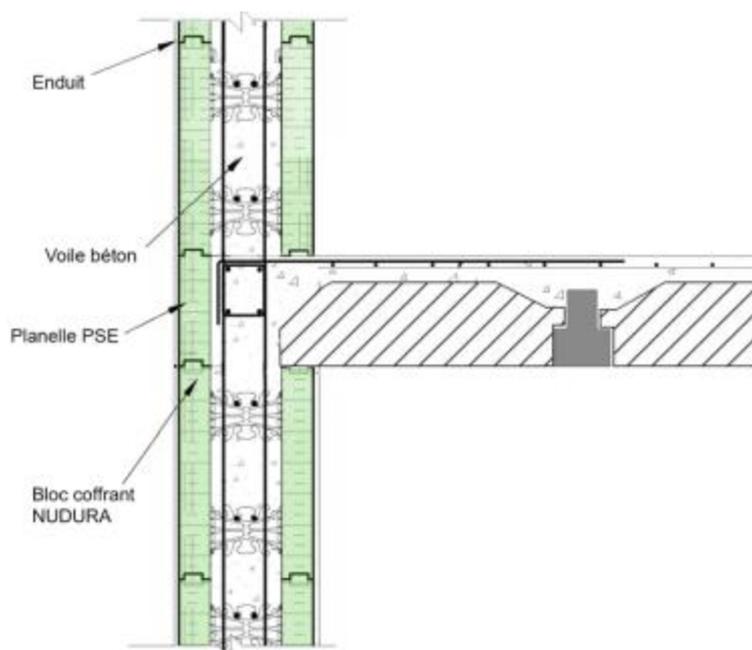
Traitement des jonctions Mur Nudura / Planchers
